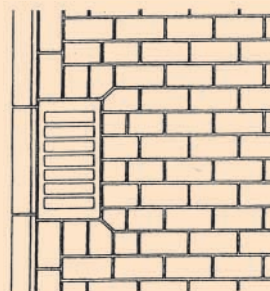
Formación de un canal de entrada con ayuda de elementos prefabricados para canalizaciones de hormigón y cubierto de tapa de fundición. Colocación del pavimento en lecho de arena sobre capa portante de hormigón. Además de las pendientes necesarias de 2,5 cm/m se ha de prever evacuación del agua, como en el ejemplo de los canales, entradas de agua o drenajes. Este tipo de medida depende del estado o modalidad de las capas portantes, y del subsuelo así como de la forma de colocación.
